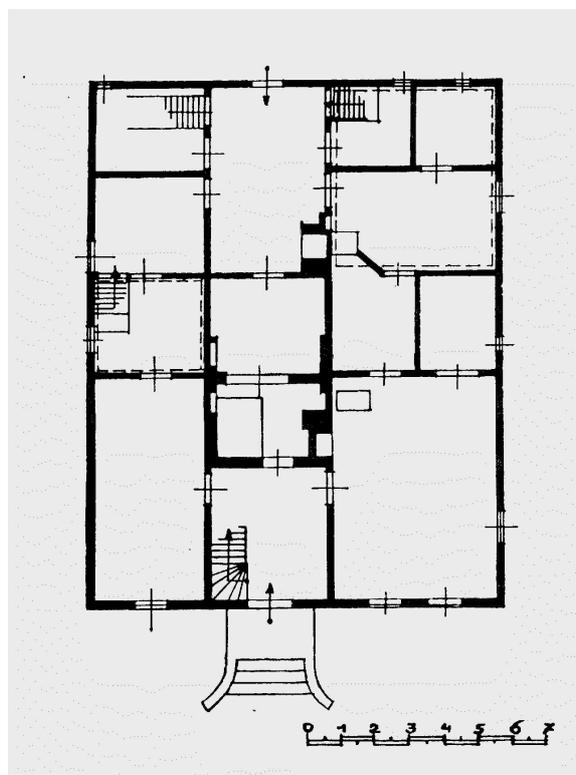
Grundriss des Wohnhauses Altwriezen 23, erbaut 1802
